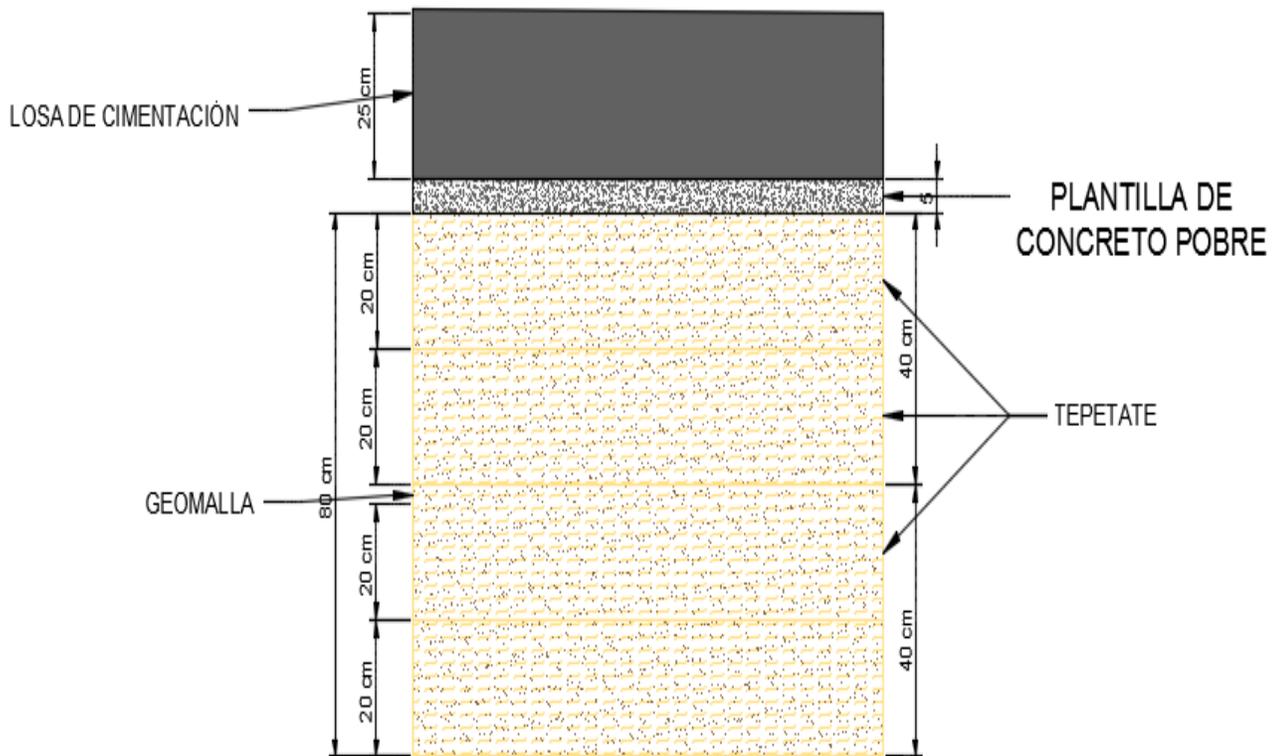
MEJORAMIENTO RECOMENDADO
